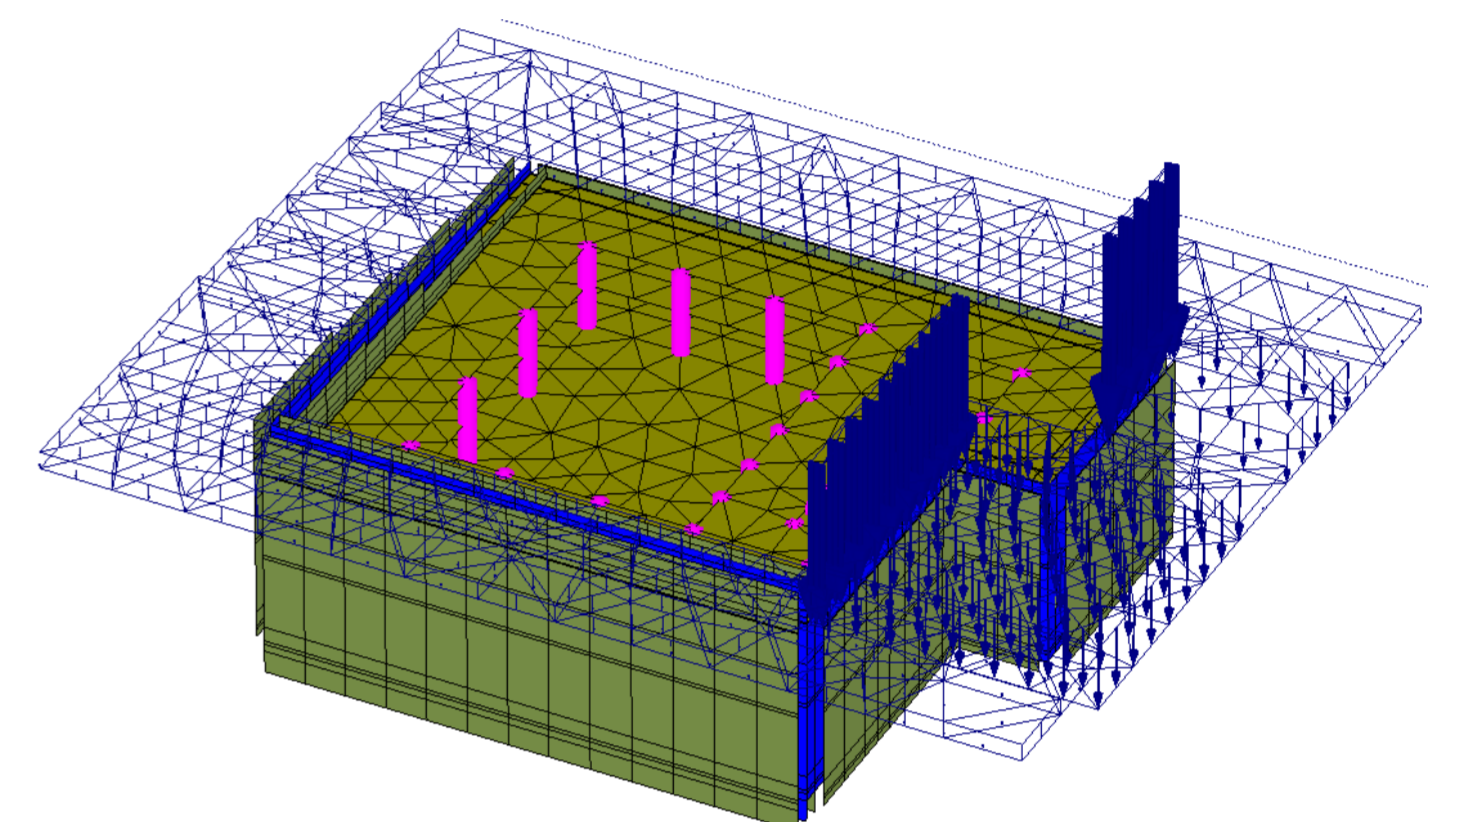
3D-FE-Modell der Baugrube in Deckelbauweise mit Lasten
